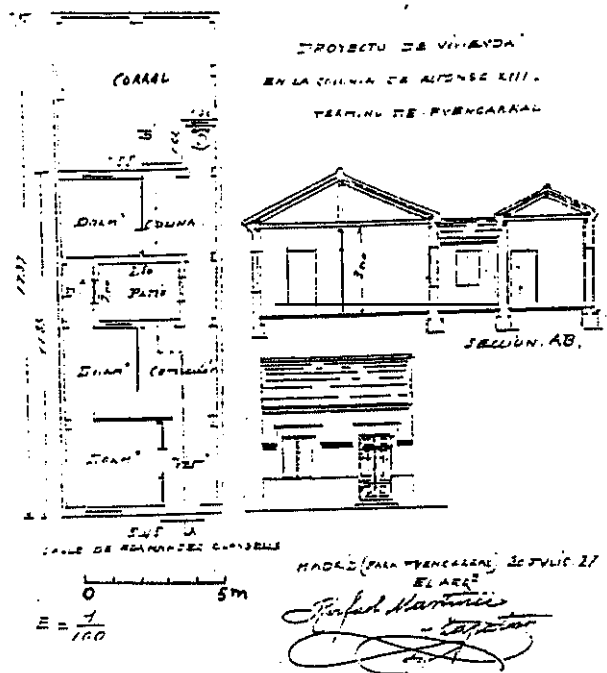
Adaptación de las viviendas al trazado parcelario.
